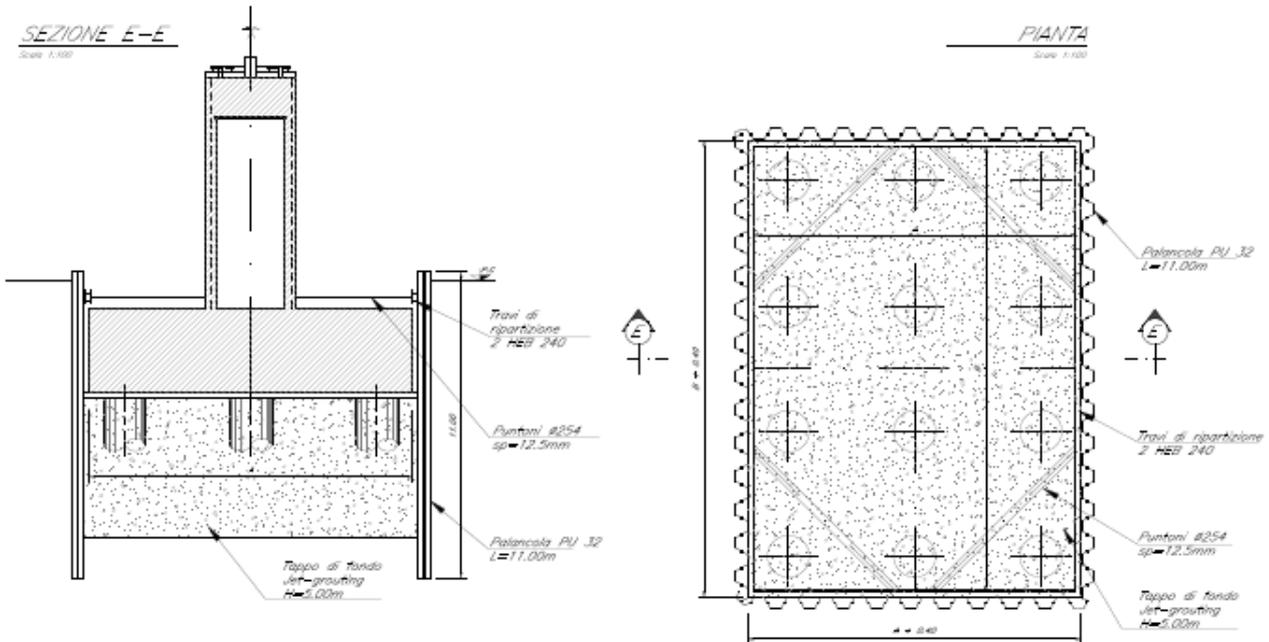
Prospetto e sezione pila campata L=69.70 m /45.00 m
